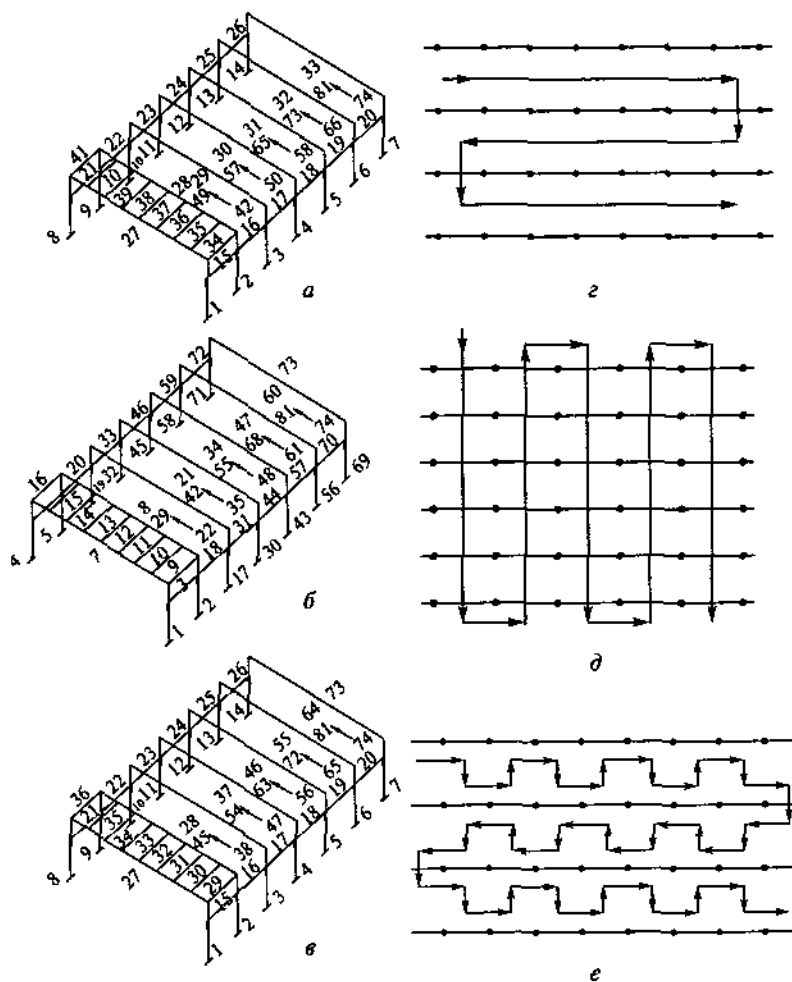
Монтаж конструкций одноэтажных промзданий:
